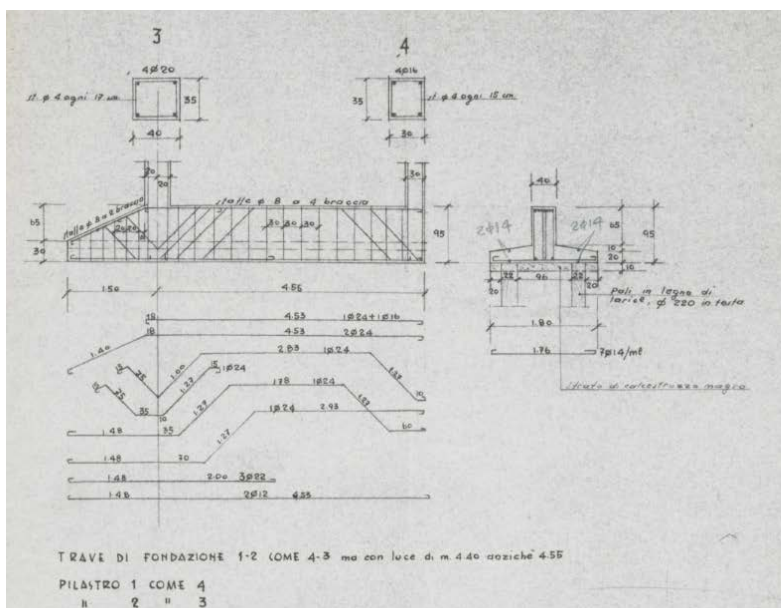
Estratto tavola fondazioni, dettaglio trave di fondazione (1960) - (Archivio del Comune di Padova)
